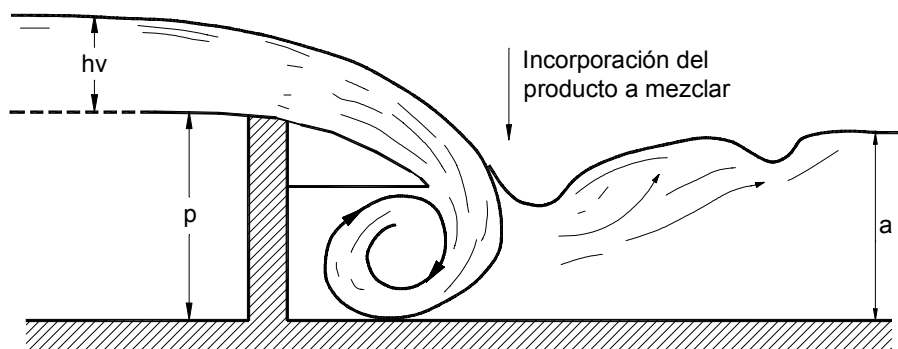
Corte de un vertedero ubicado en un canal de ancho b (m), utilizado como mezclador
